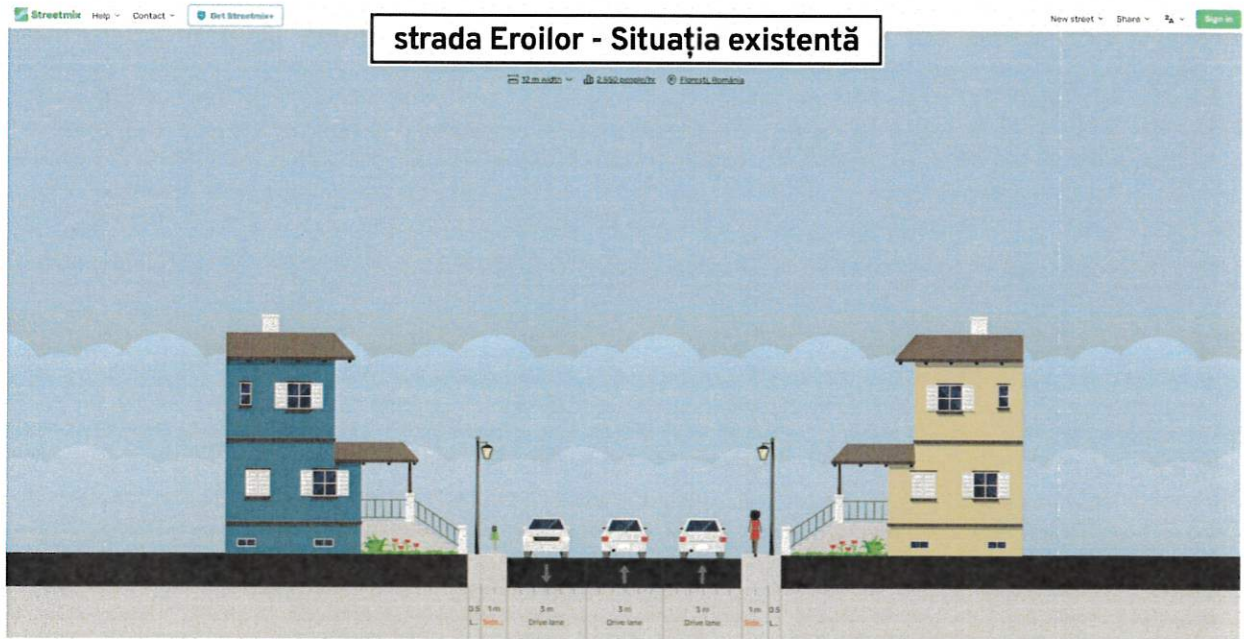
Profil transversal tip - Str. Eroilor situație existentă
